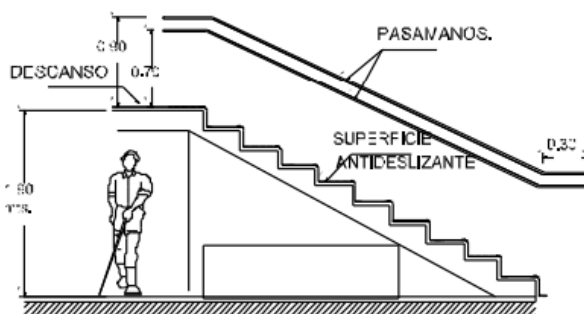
Detalle en elevación de gradas. Fuente: sitio web.
